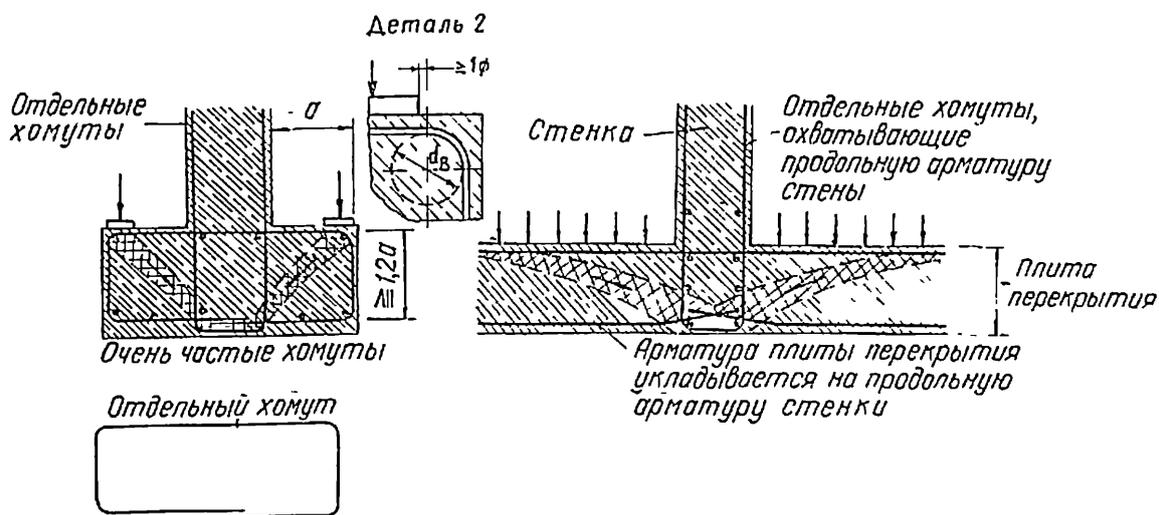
12б. Армирование узлов соединения балок-стенок с нижним поясом, предназначенным для передачи подвесной нагрузки
